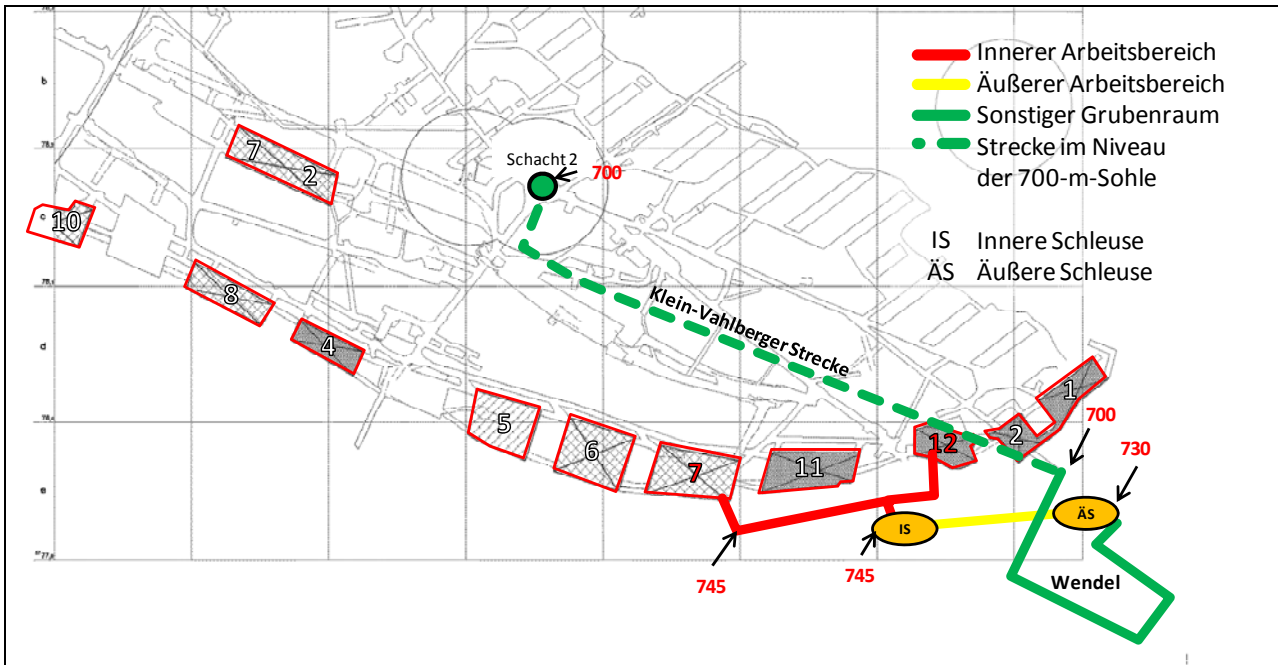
Schematische Darstellung der Mischvariante– Rückholung zum Zeitpunkt Faktenerhebung Schritte 2 und 3 (Hintergrund: Grundriss der 750-m-Sohle).
